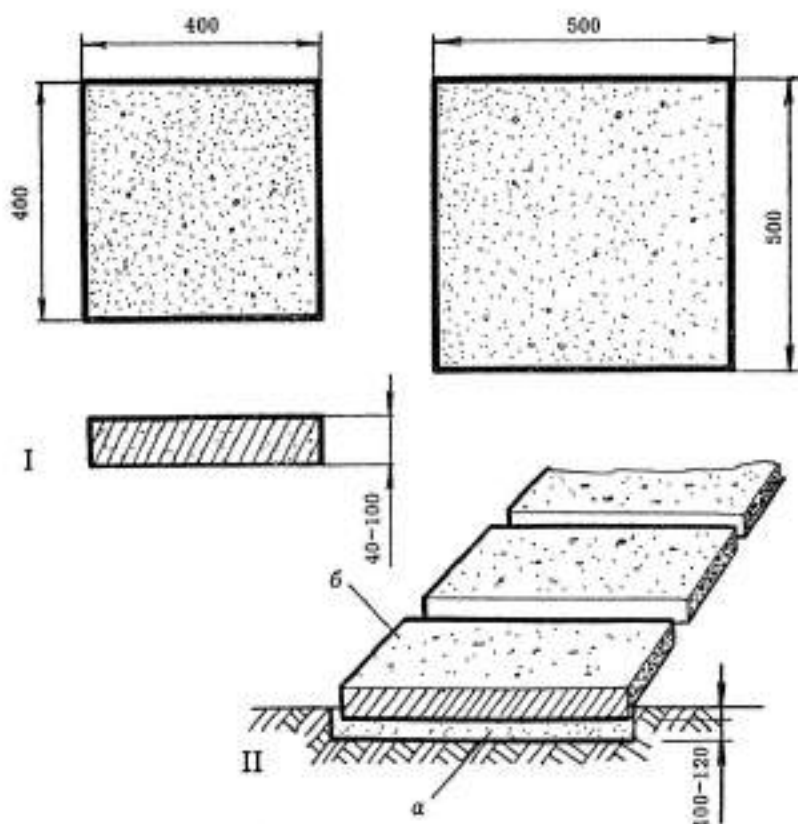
Укладка бетонных плит: I — варианты размеров плит заводского изготовления; II — профиль дорожки из бетонных плит с большим промежутком: а — песок слоем 10–12 см; б — бетонная плита
